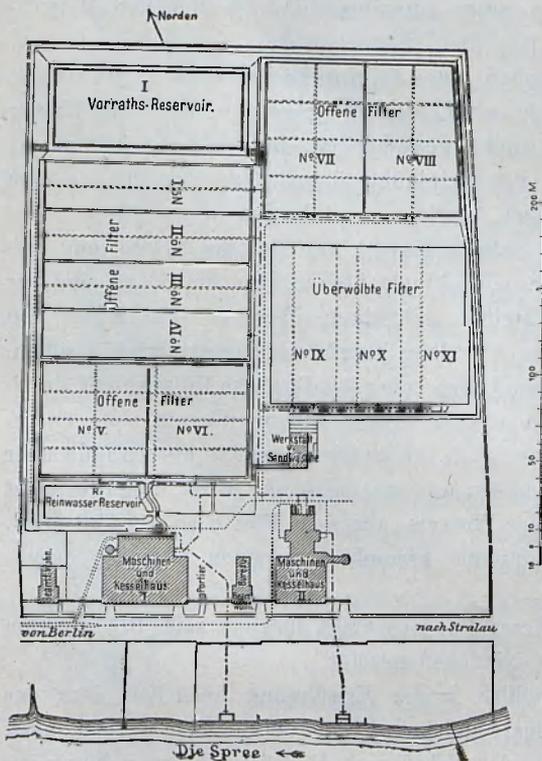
Situationsplan der städtischen Wasserwerke zu Berlin vor dem Stralauer Thor.
